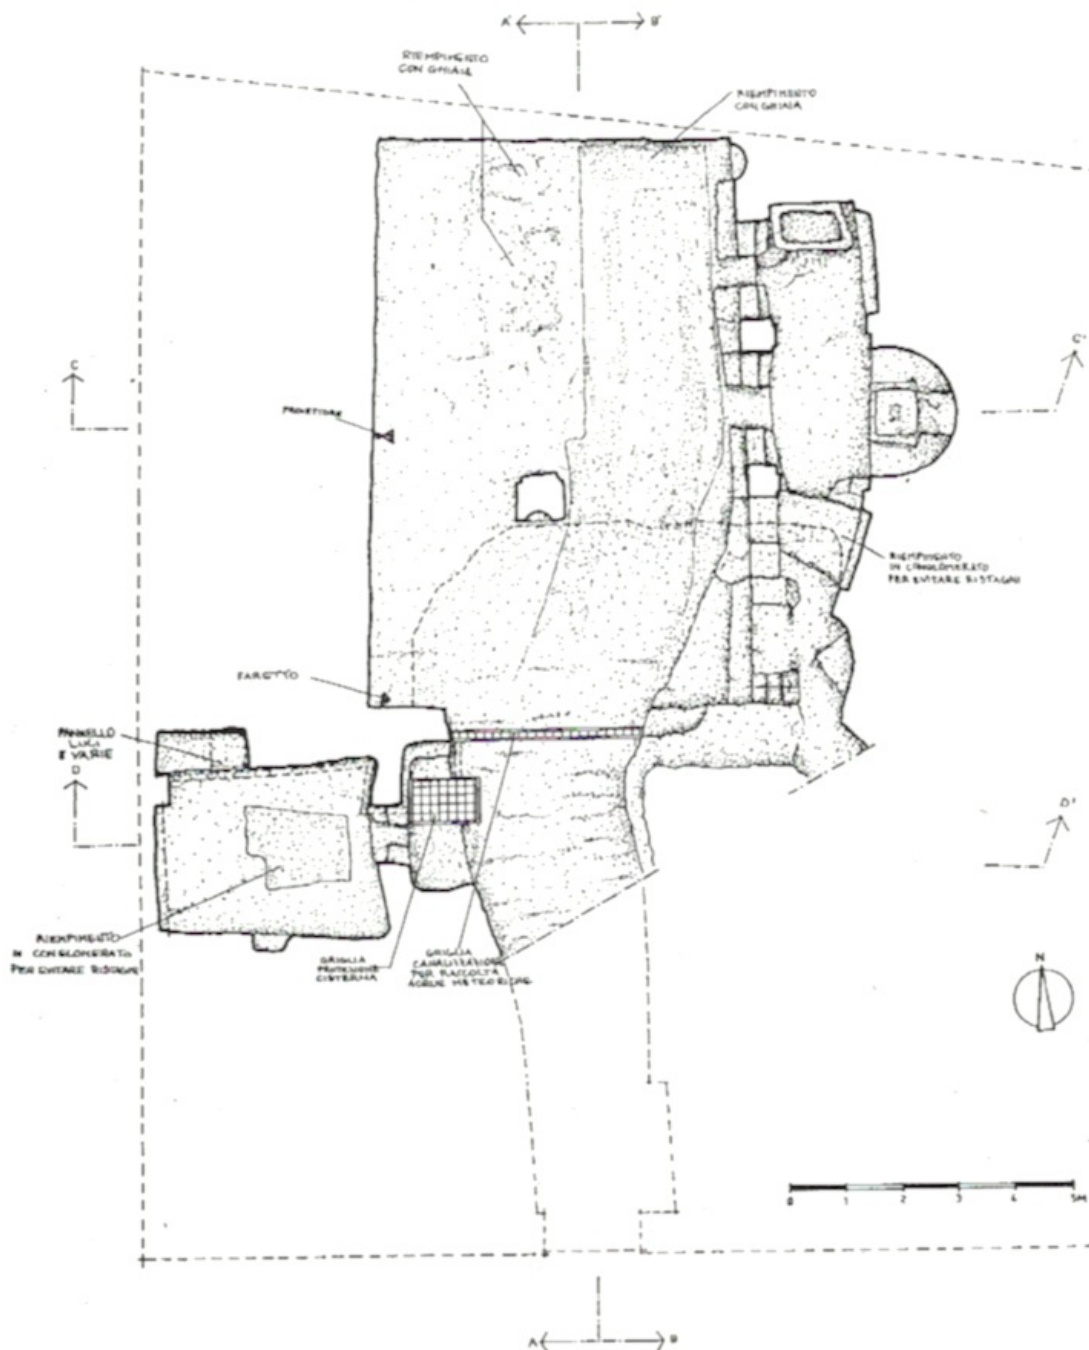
Particolare della pianta della chiesa di San Leonardo nel progetto realizzato.
